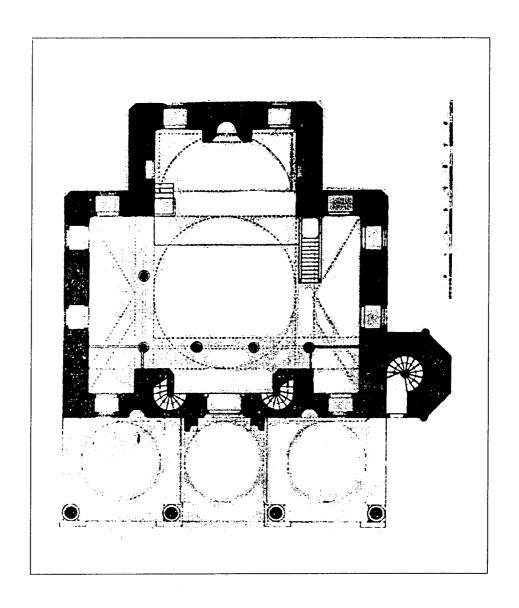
مسقط أفقي لمسجد مسيح باشا في إستانبول (عن : عبد الحافظ).
